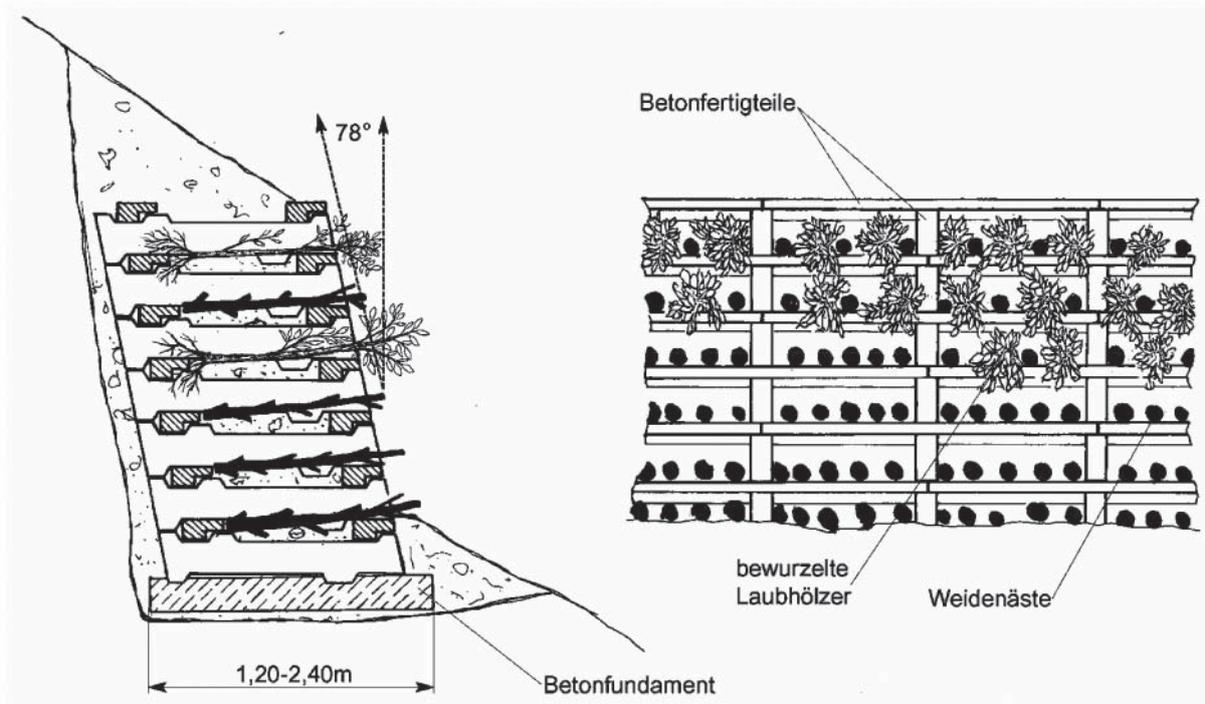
Schema einer bepflanzten Betonkrienerwand mit Gehölzeinlagen
